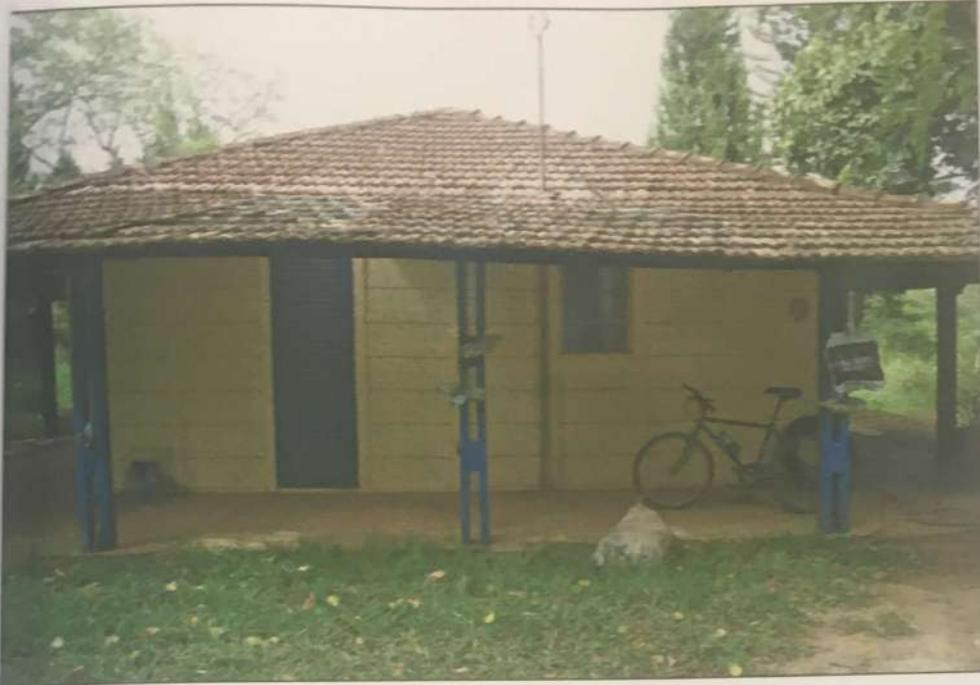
Fachada frontal da casa principal (igual às fls.131)
